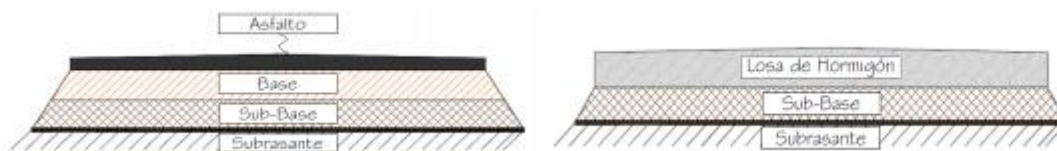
Partes que constituyen una estructura típica de un pavimento flexible y rígido.
